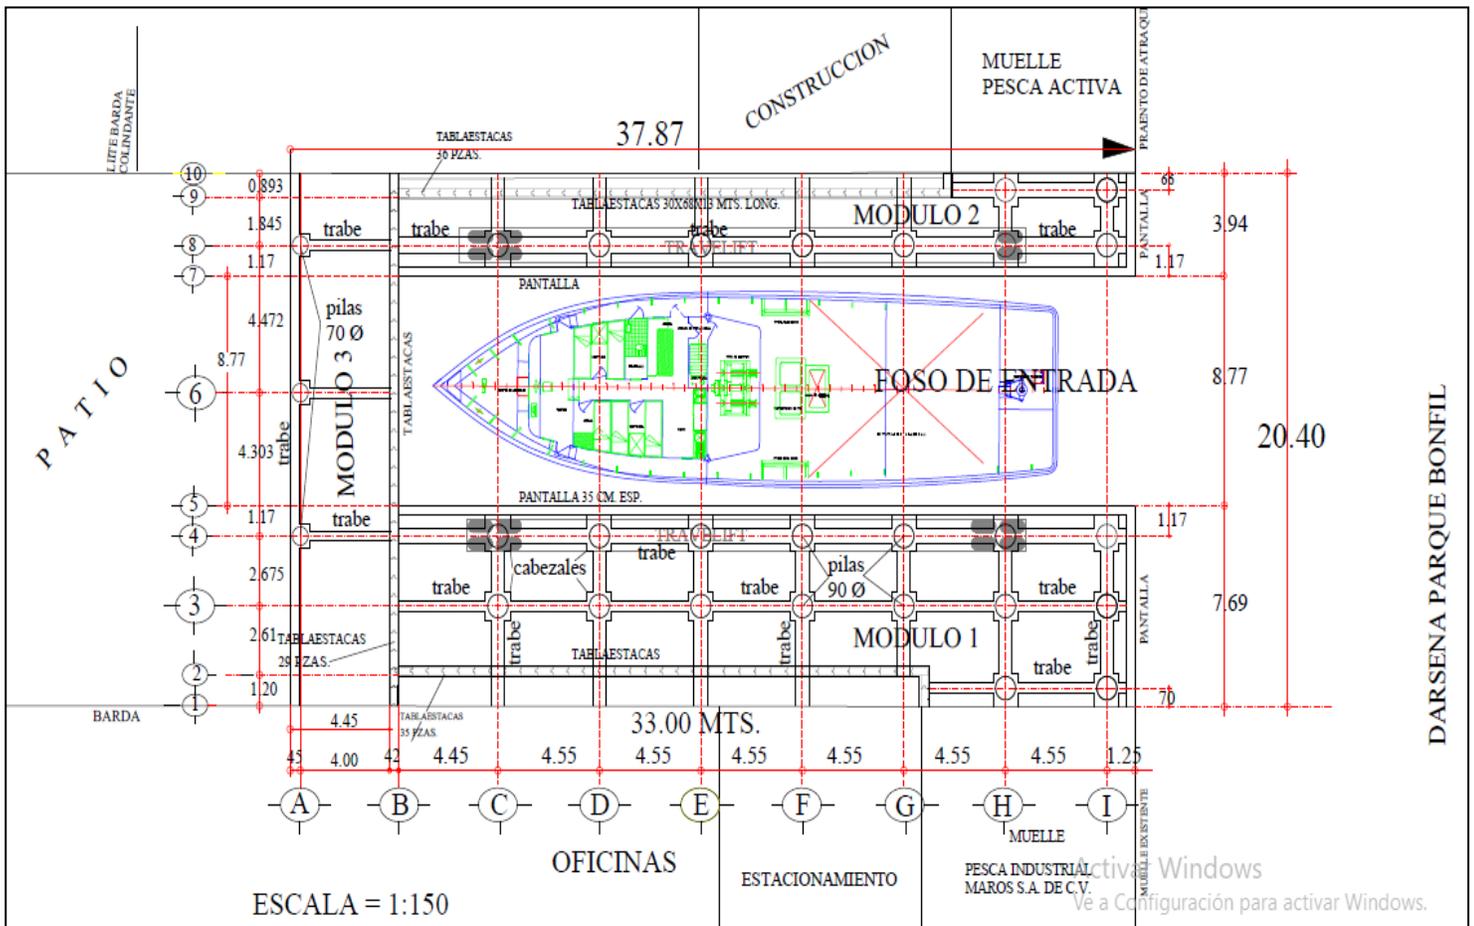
Foso de Entrada y cantidades de concreto y acero reforzado. (Plano Ejecutivo # 3)
